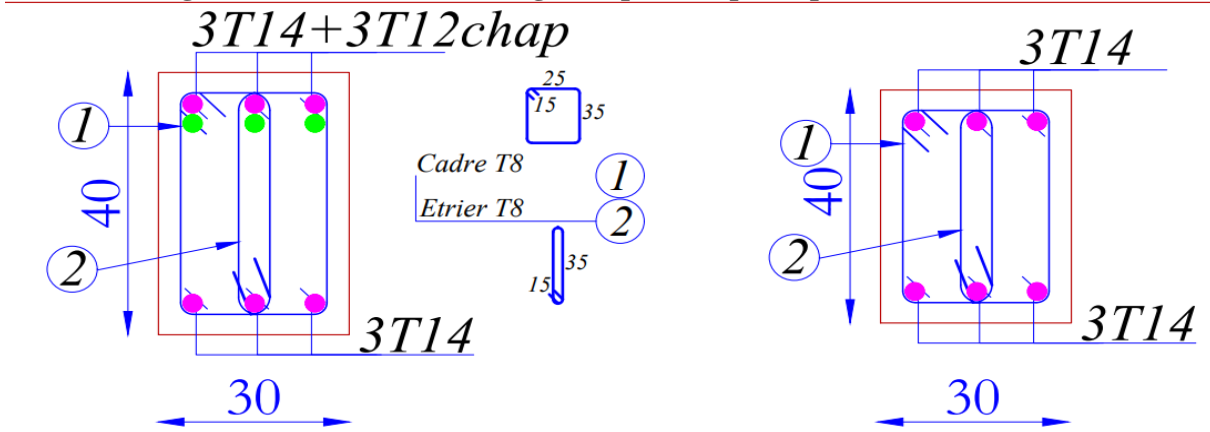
schéma de ferraillage des poutres principales non associées au voile.
